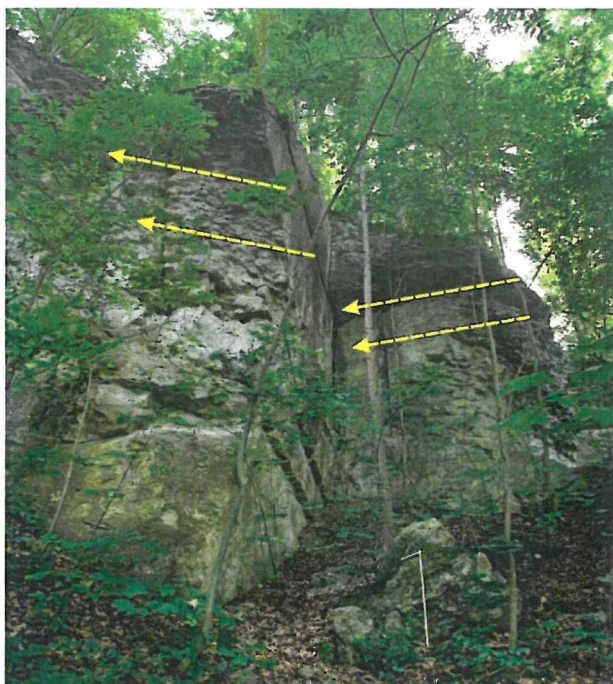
Další skalní útvary druhého geomorfologického stupně na východ od objektů zachycených na foto 10, 11. *Žluté čárkované šipky* naznačují jejich stabilizaci kotvením.
